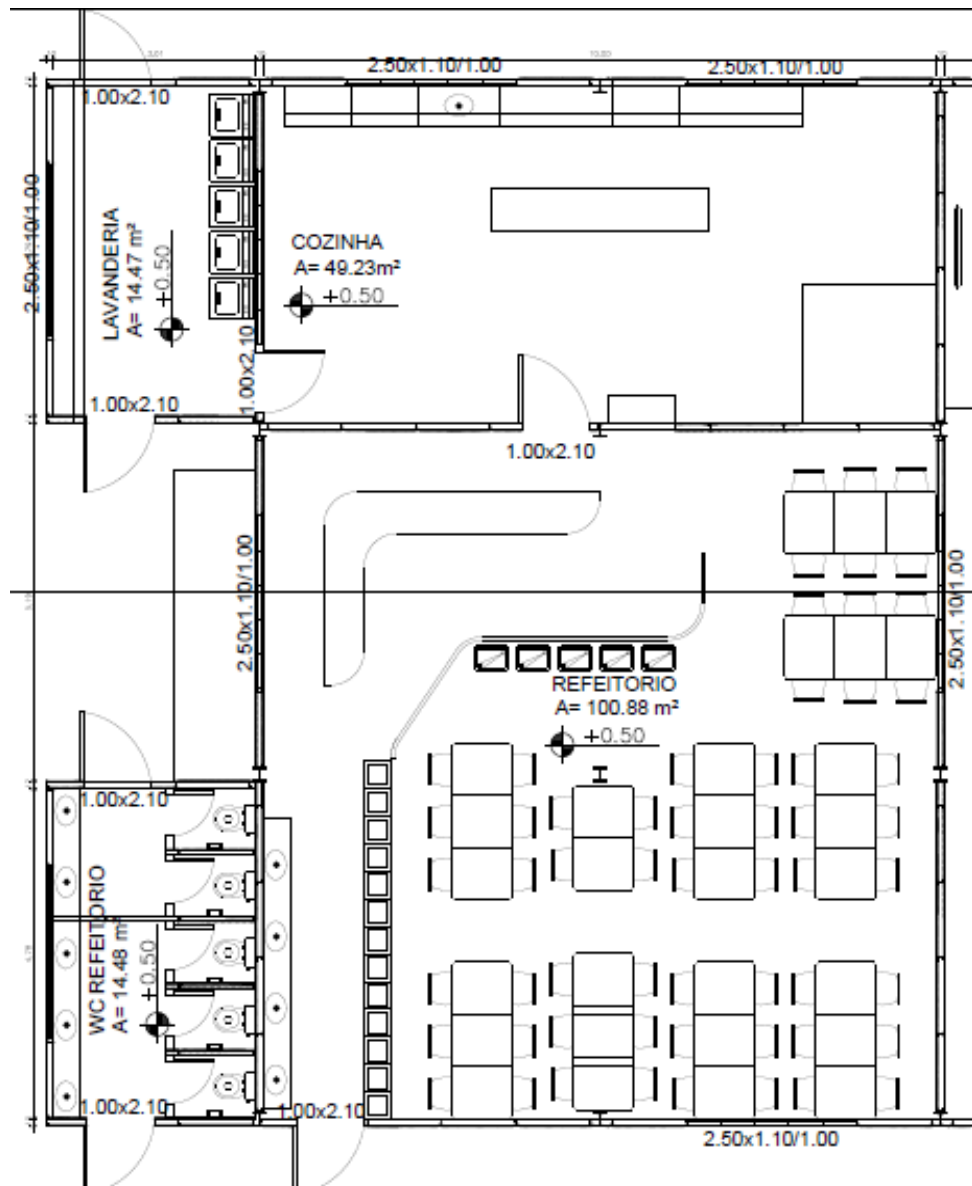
Planta baixa do refeitório/cozinha/lavanderia.
